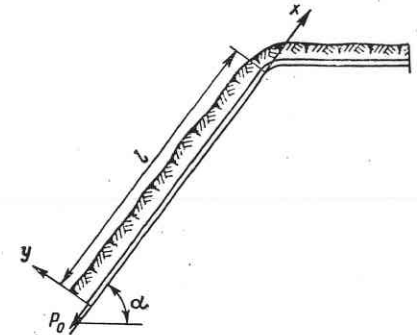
Схема трубопровода на продольном уклоне при наличии граничной силы
